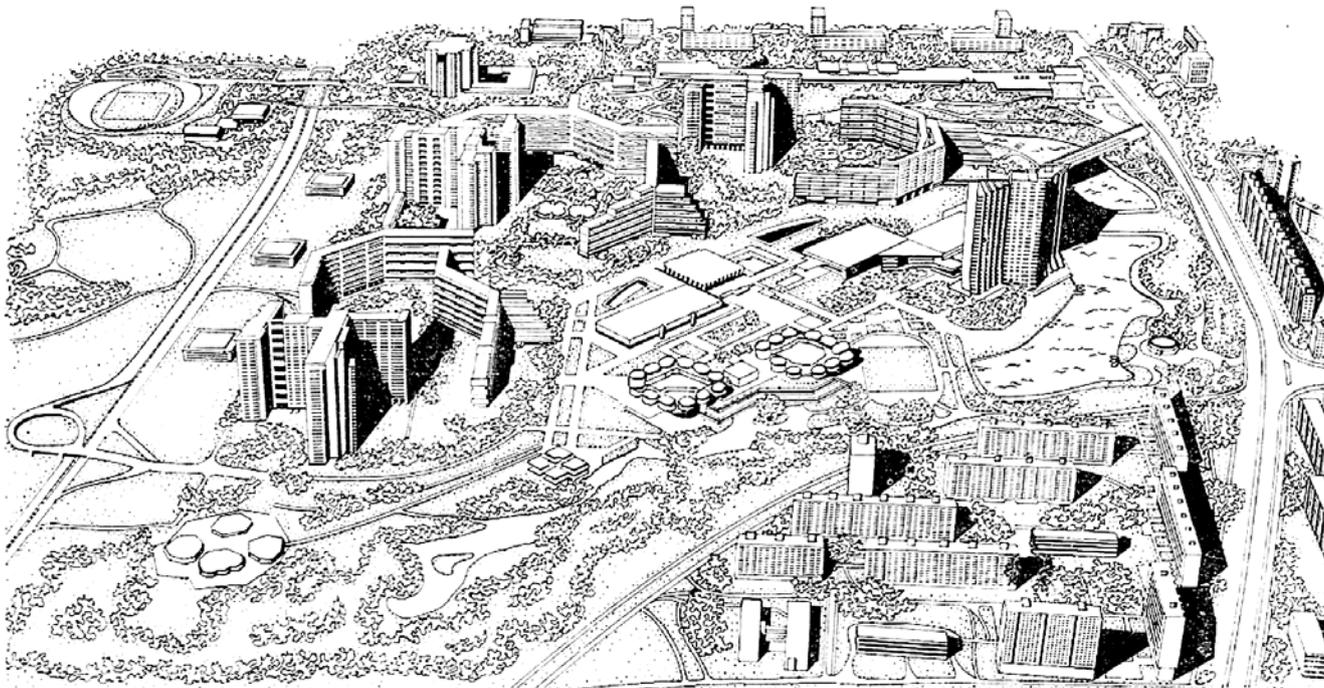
Общий вид ОПЖР Чертаново-Северное
